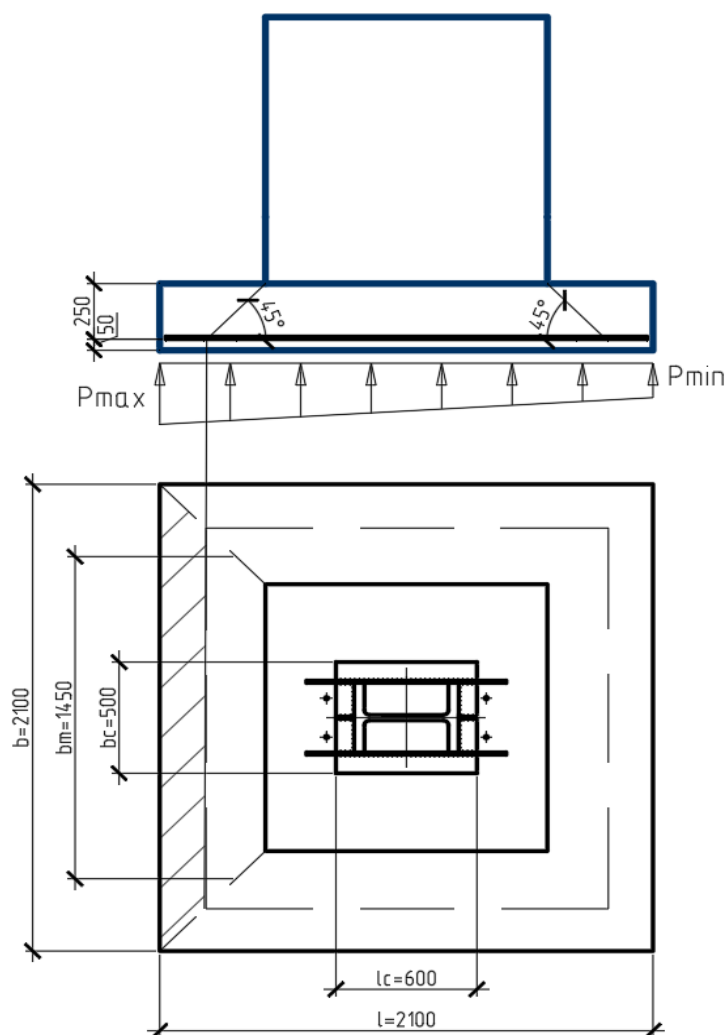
Схема до розрахунку низького фундаменту на продавлювання підколонником
